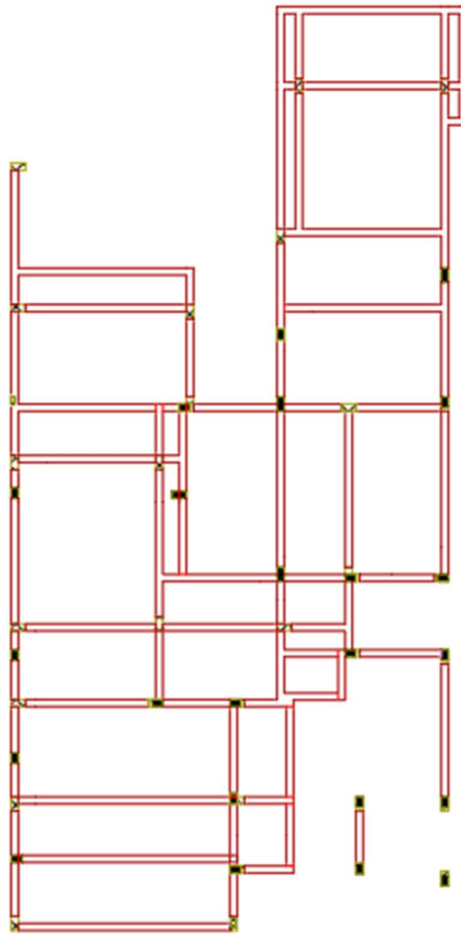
Distribución de columnas en Planta Alta (Boza y D'Steffano, 2023)
